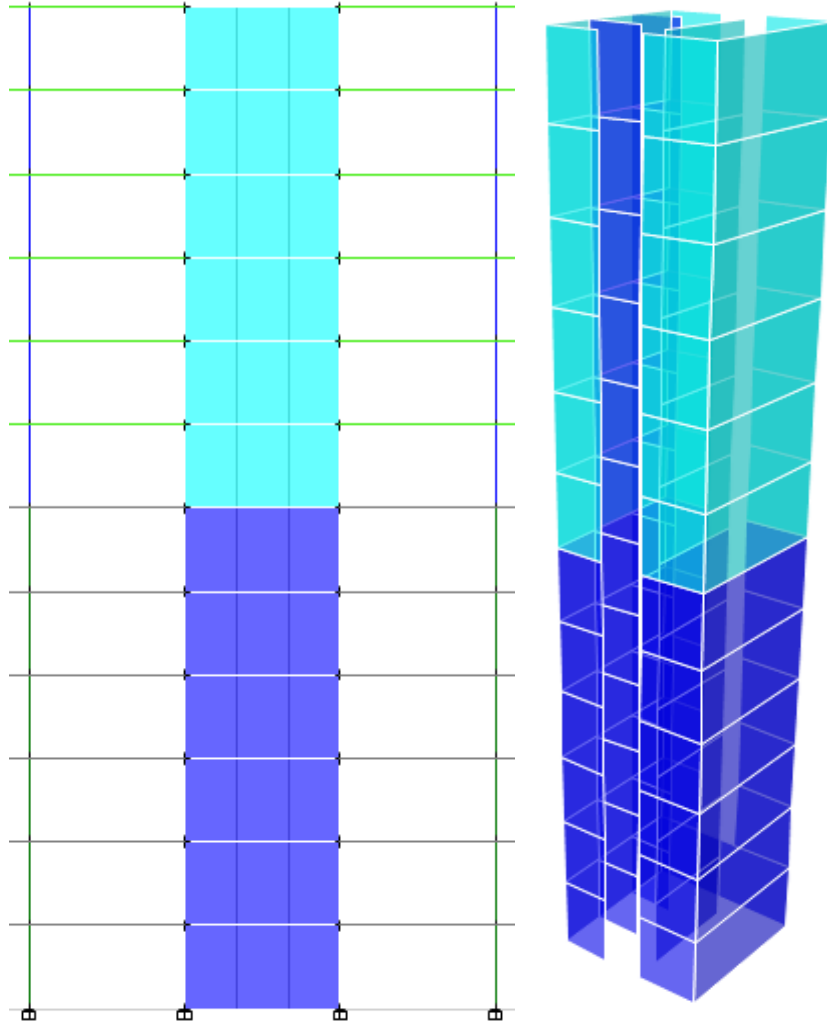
6: Vista en Elevación y 3D de la Caja escalera y ascensor, edificio tipo A.
